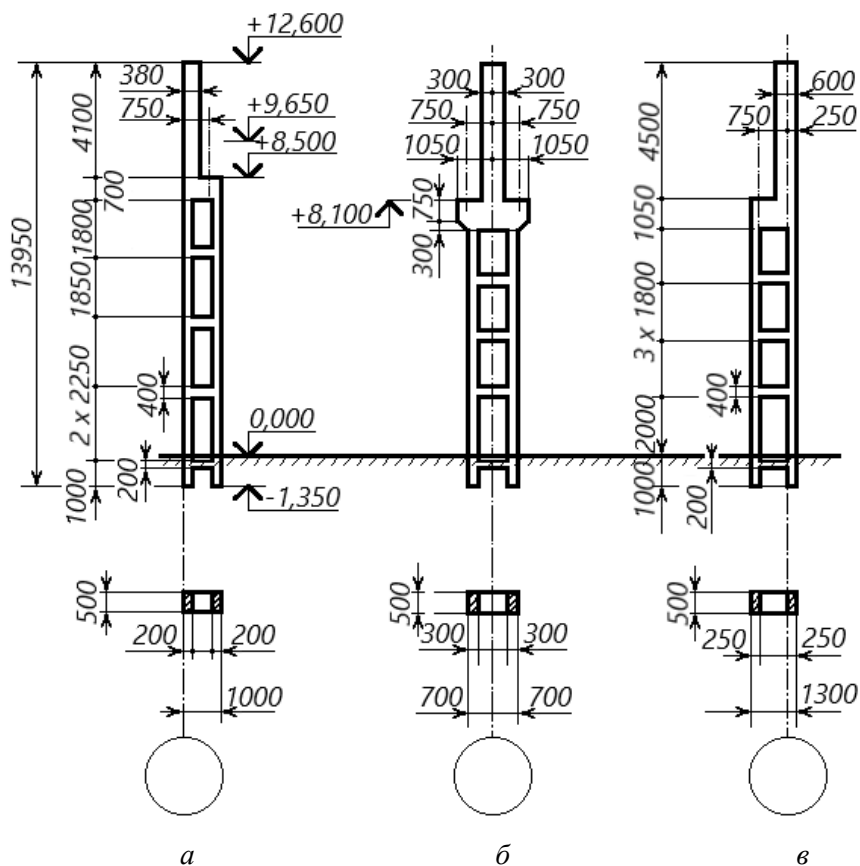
Типові двовіткові колони для будівель висотою 12,6 м з кранами вантажністю 100 кН або 200/50 кН, або 300/50 кН прольотами 18 м або 24 м, або 30 м; *а* – крайня колона з кроком 6 м, *б* – середня колона з кроком 12 м, *в* – крайня колона з кроком 12 м
